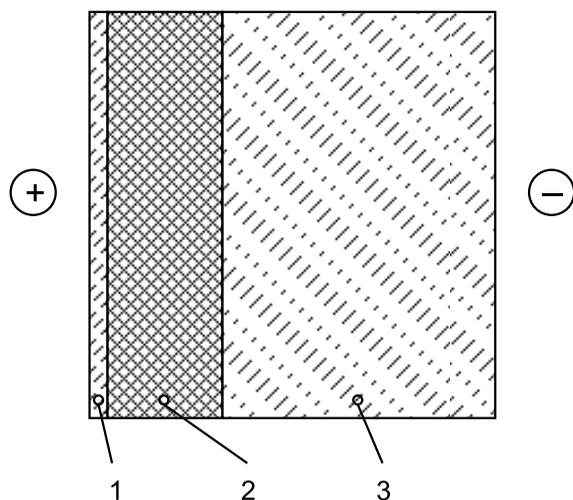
Конструкция наружной стены, утепленной с внутренней стороны беспесчаным керамзитобетоном:
